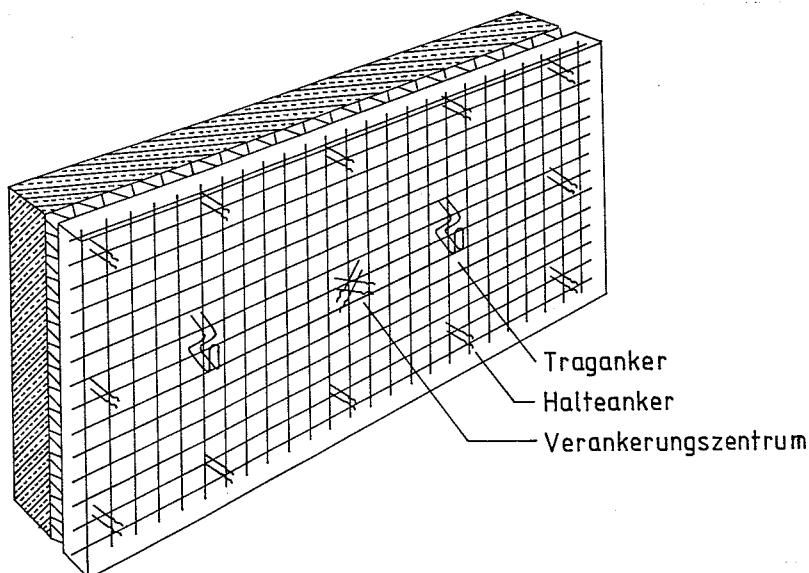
Betonsandwichtafel mit zwei in Horizontalrichtung biegeweichen Tragankern außerhalb des Bewegungsruhepunkts
